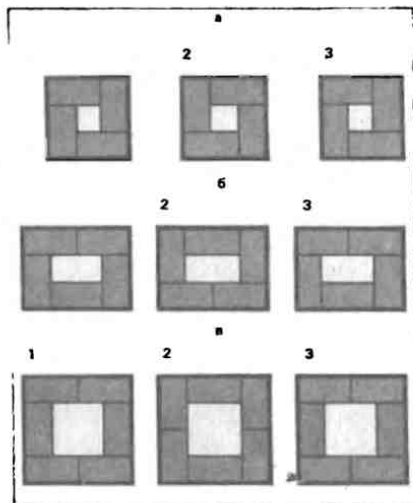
Порядовки кладки стояка дымовых труб с площадью сечения
